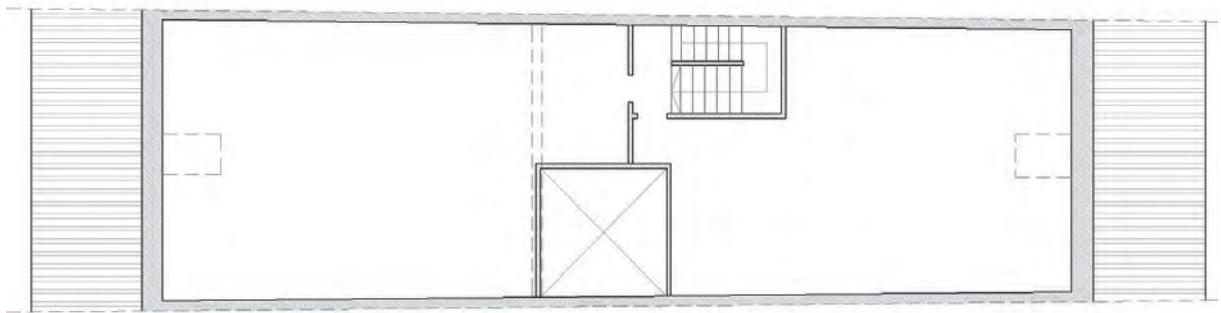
10. PLANTA BAJOCUBIERTA
